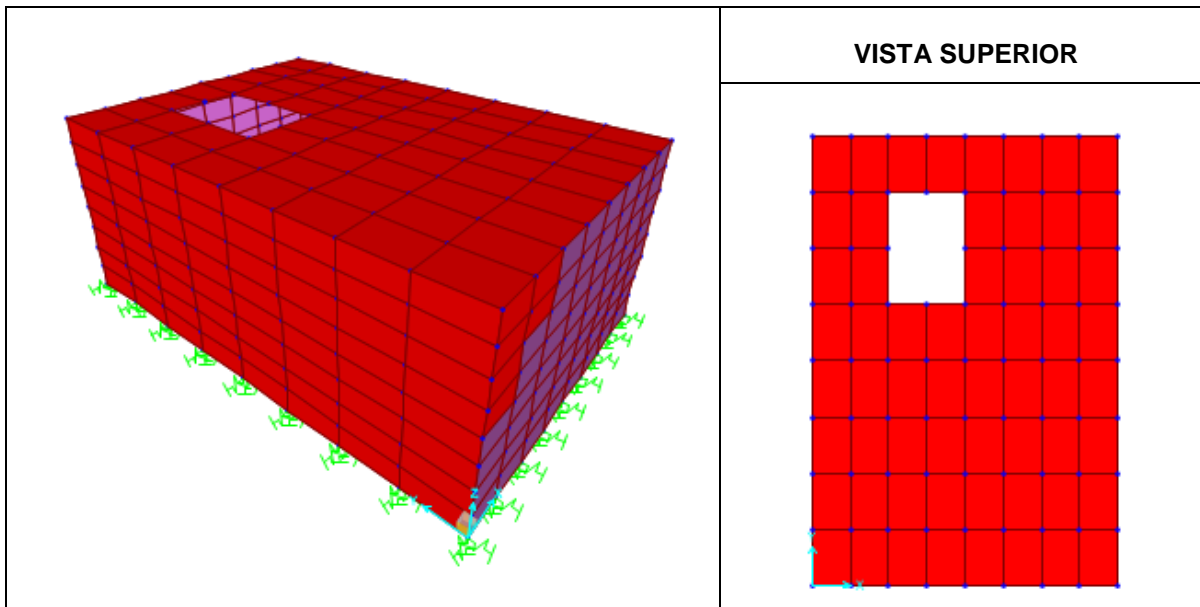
VISTA ESTRUCTURA DE TANQUE. A) VISTA GENERAL (Vista izquierda) B) VISTA SUPERIOR (vista inferior derecha).
